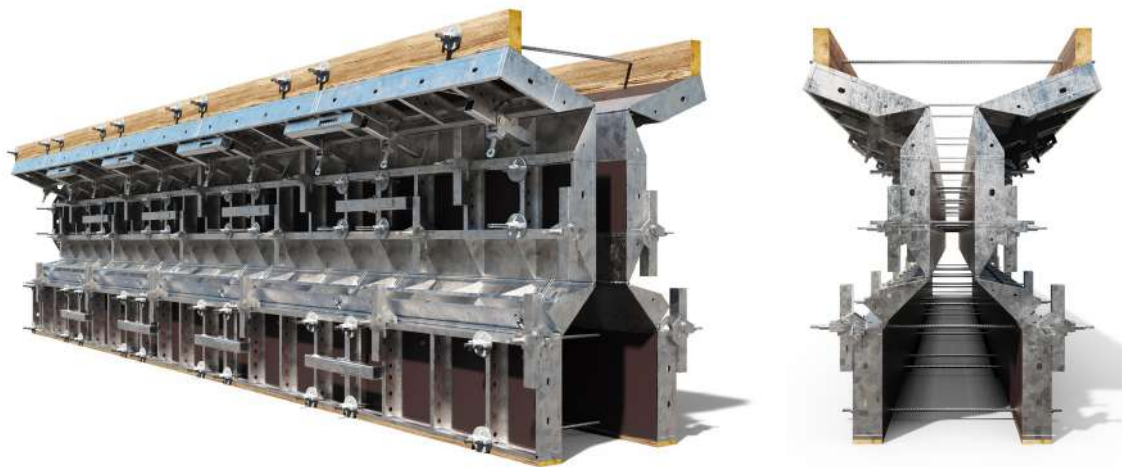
Fôrmas Concreform SH® para vigas pré-moldadas
